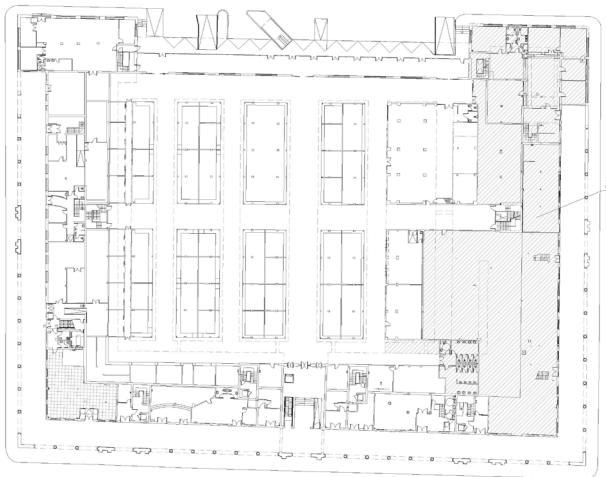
Planta baja del Mercado y zonas de actuación Fases 1 y 2.
